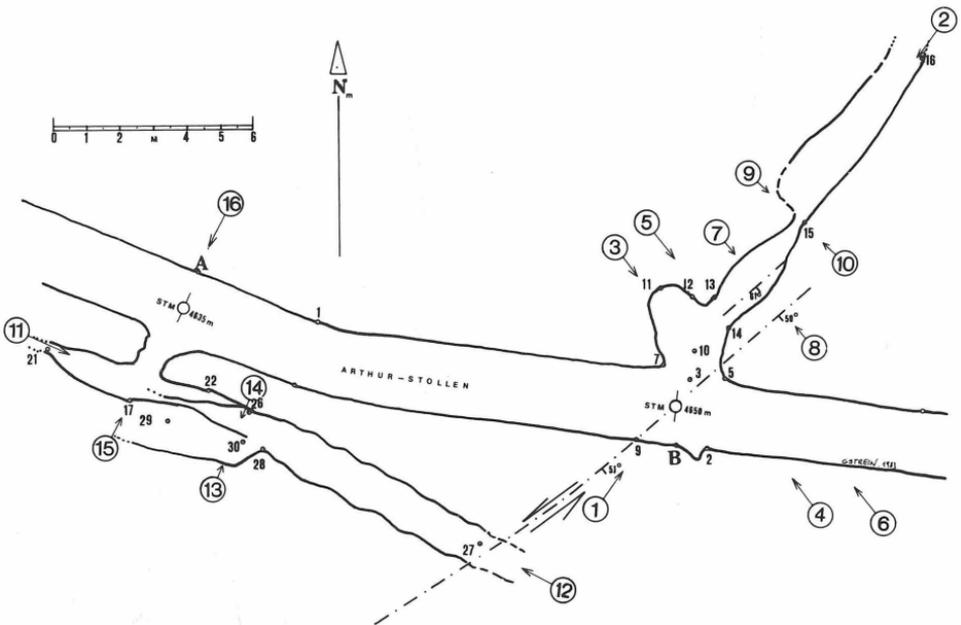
Grundrißdetaildarstellung (z. T. etwas vereinfacht) der aufgenommenen Teile der „Keltensollen“ mit Angabe der Lage der entsprechenden Profile.
